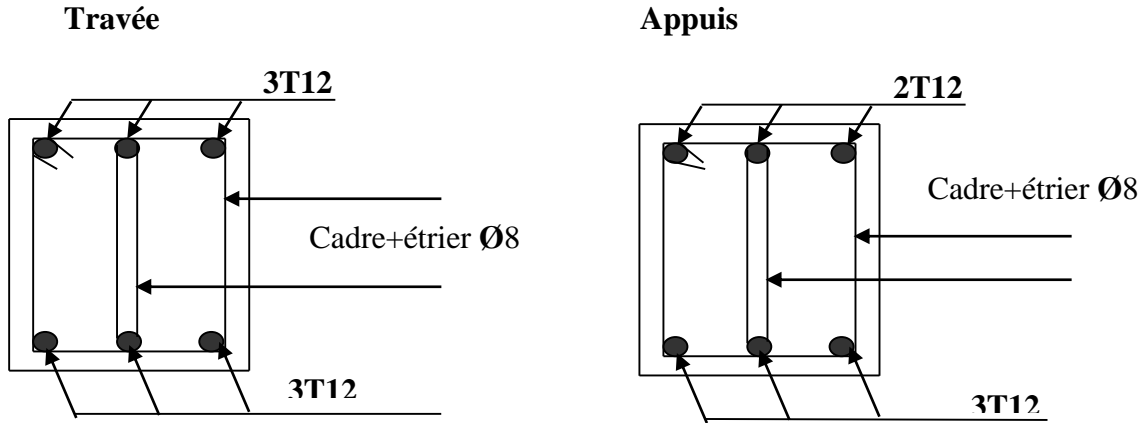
Schéma de ferrailage de la poutre palière .
